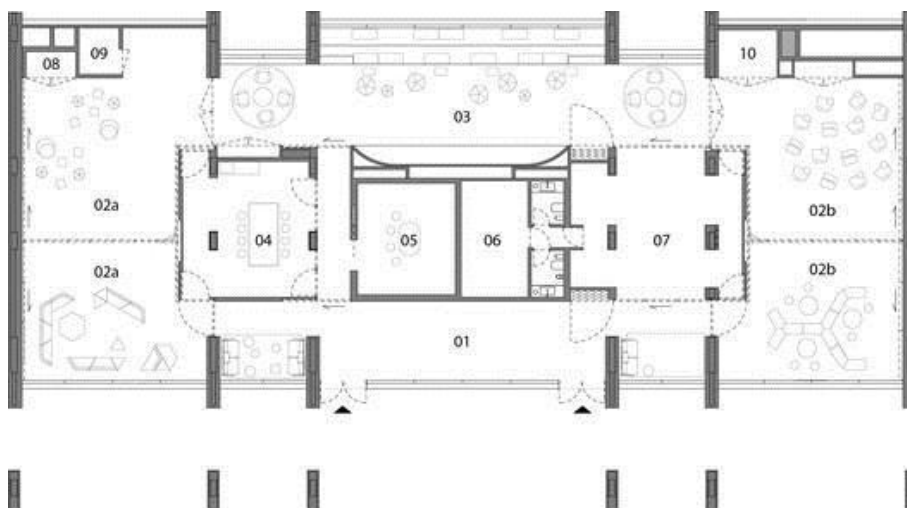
Rzut aranżacji wnętrza Vittra Telefonplan [Archdaily 2022b]
